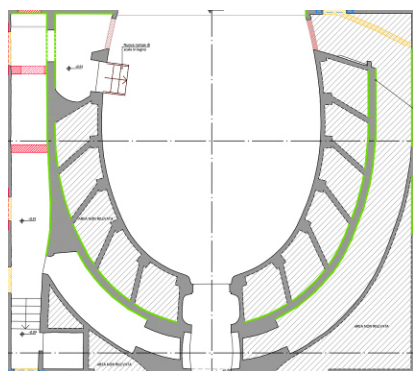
Stralcio di piano terra, in verde la muratura oggetto di consolidamento
